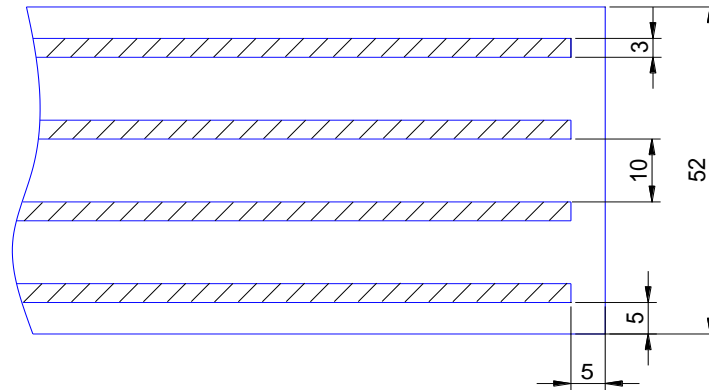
Detalle placa de neopreno reforzada (mm) (Ref. 1)
